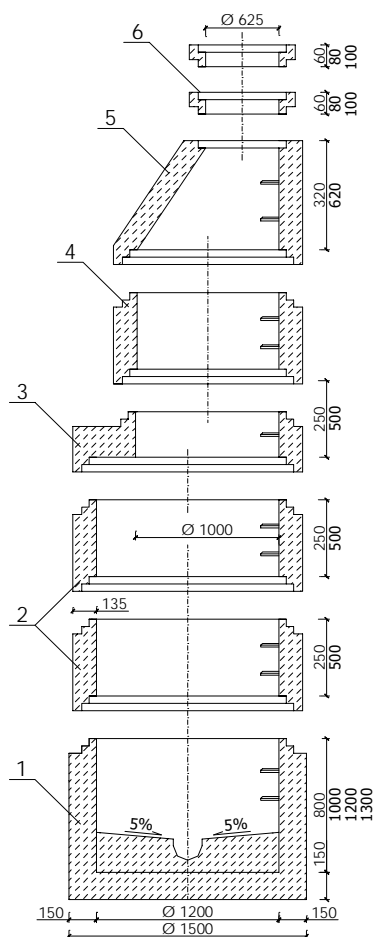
Przykładowe rozwiązanie studzienki murowanej
